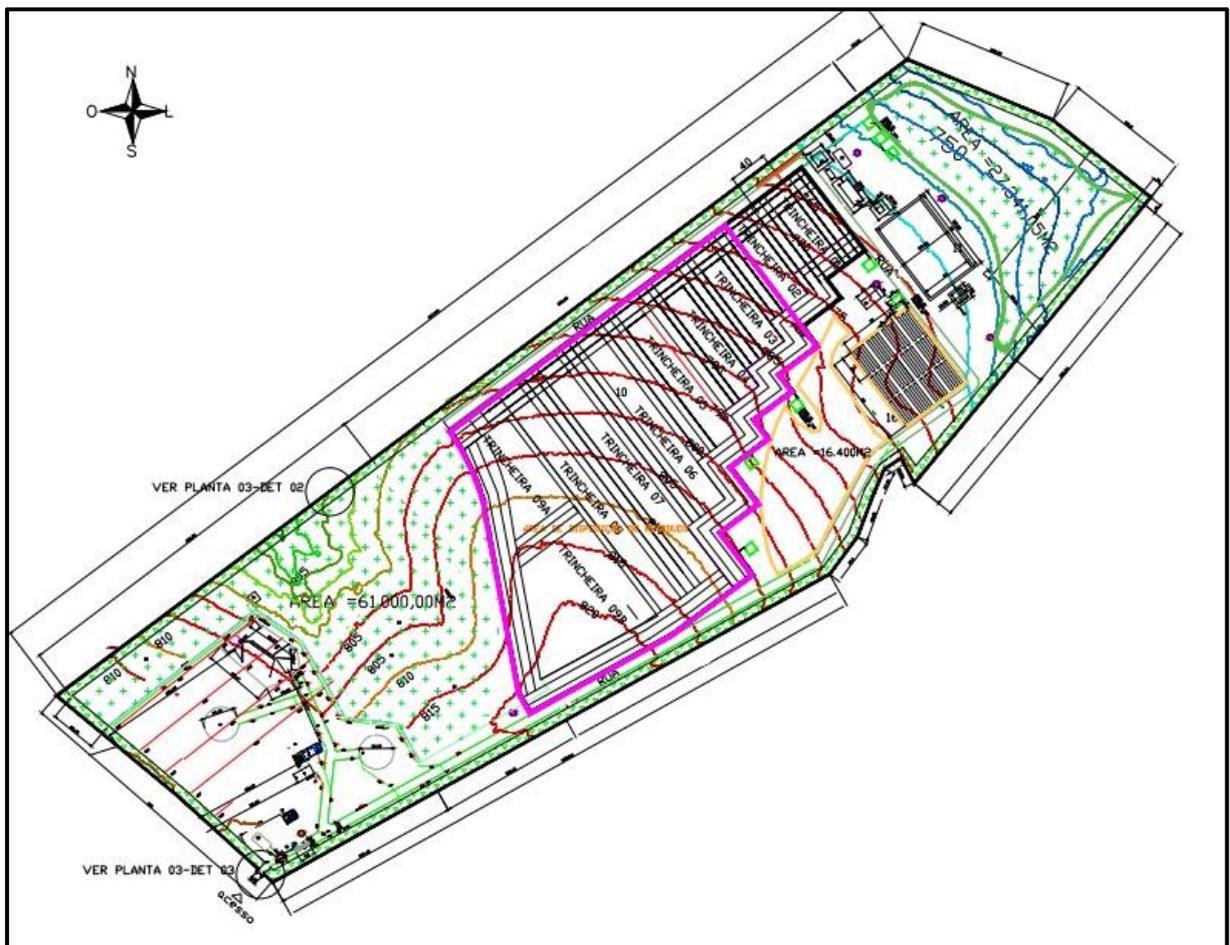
Planta com a disposição geral das estruturas do aterro sanitário de Imbaú.
